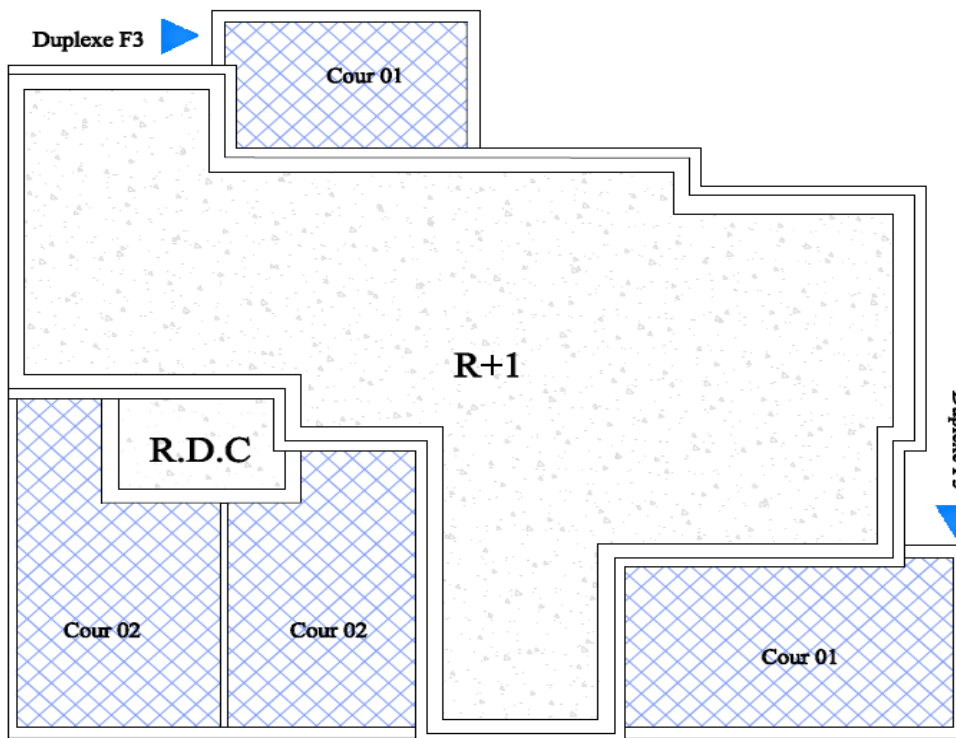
Vue en plan de toiture réalisé par autocad
